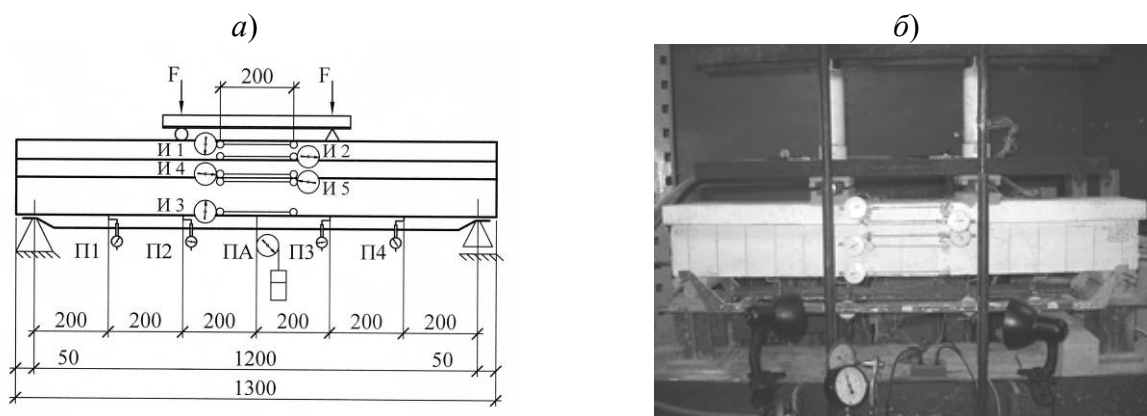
Схема испытаний: схема расстановки приборов (а); общий вид испытаний (б)
